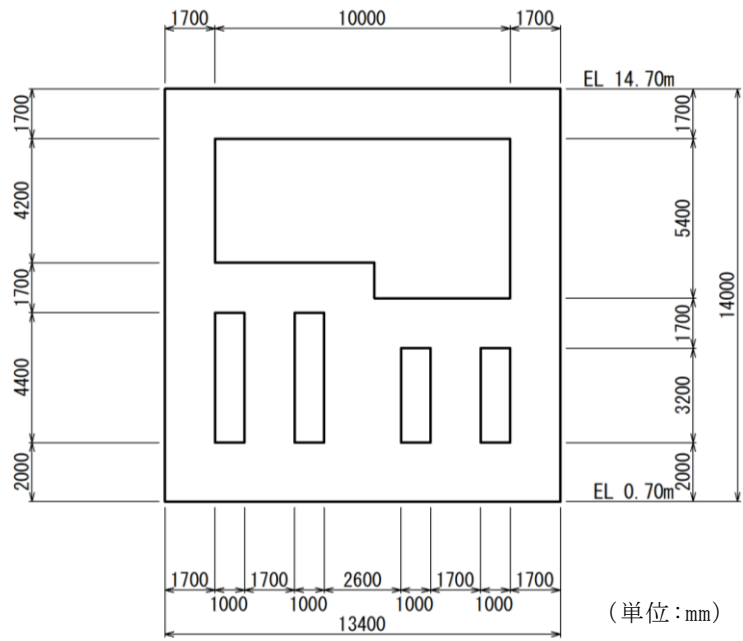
第 1 ベントフィルタ格納槽 断面図 (B-B 断面)
